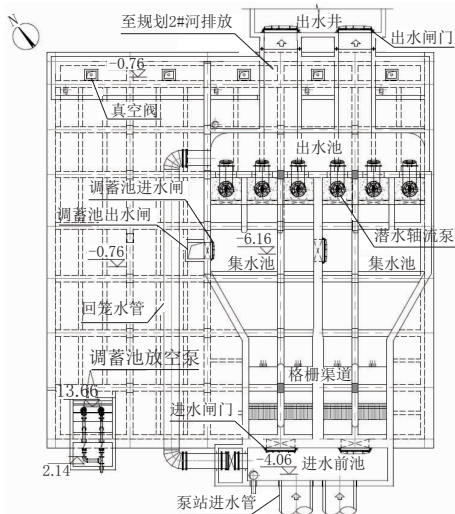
泵房及调蓄池地下 1 层平面图(单位:m)
